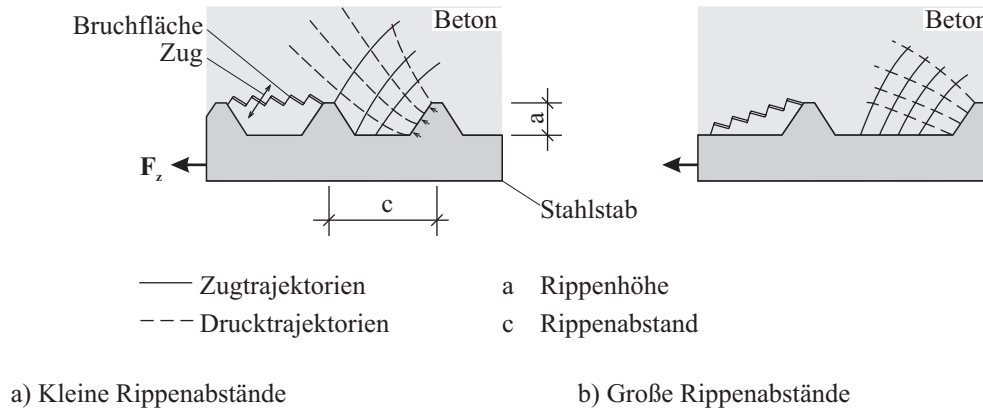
Hauptspannungen und Bruchflächen an Betonstahlrippen nach LEONHARDT [71]
